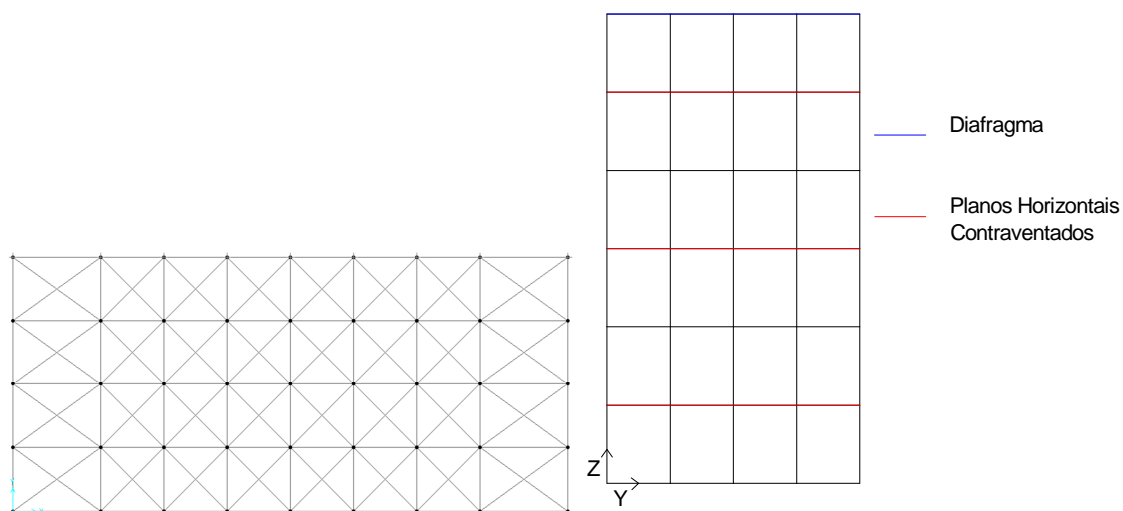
Configuração dos Planos de Contraventamento Horizontal Com Elementos de Contraventamento Pequenos
